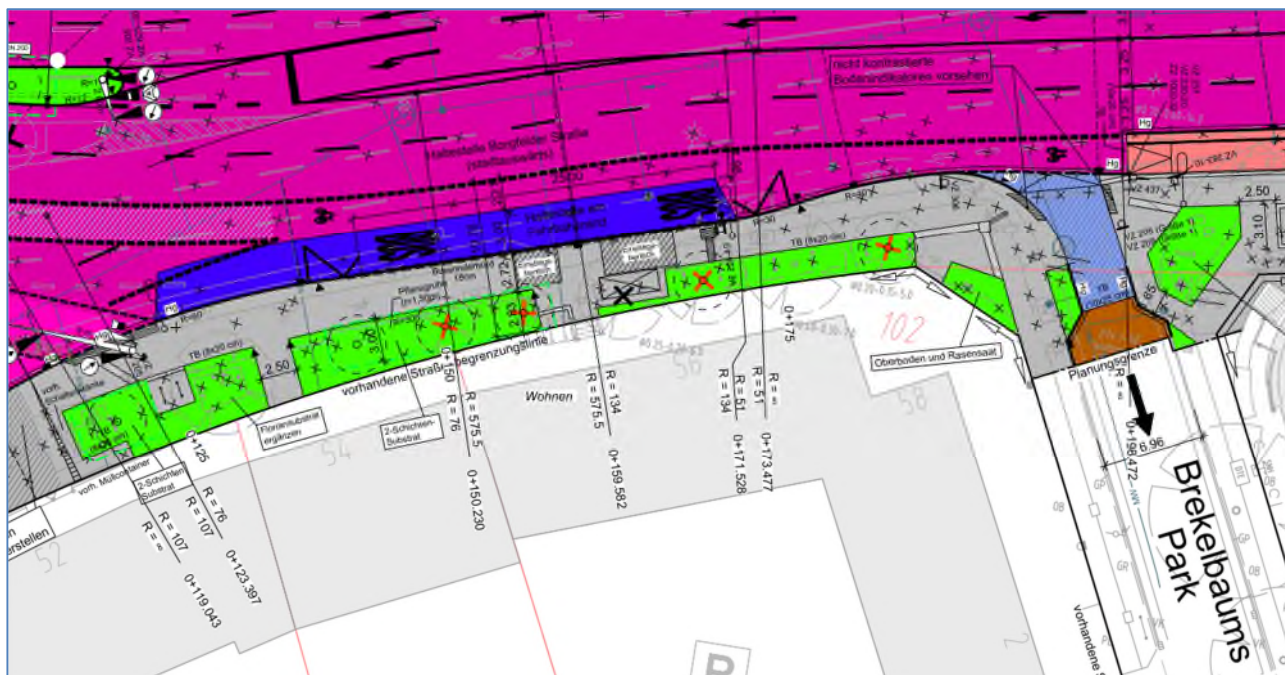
Lageplanausschnitt schlussverschickte Planung 18.06.2024
